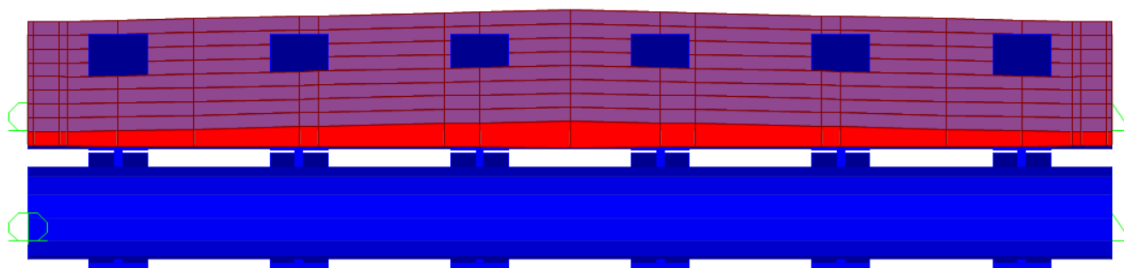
Vista da ligação no modelo estrutural das longarinas nas carlingas sem barra de rigidez
